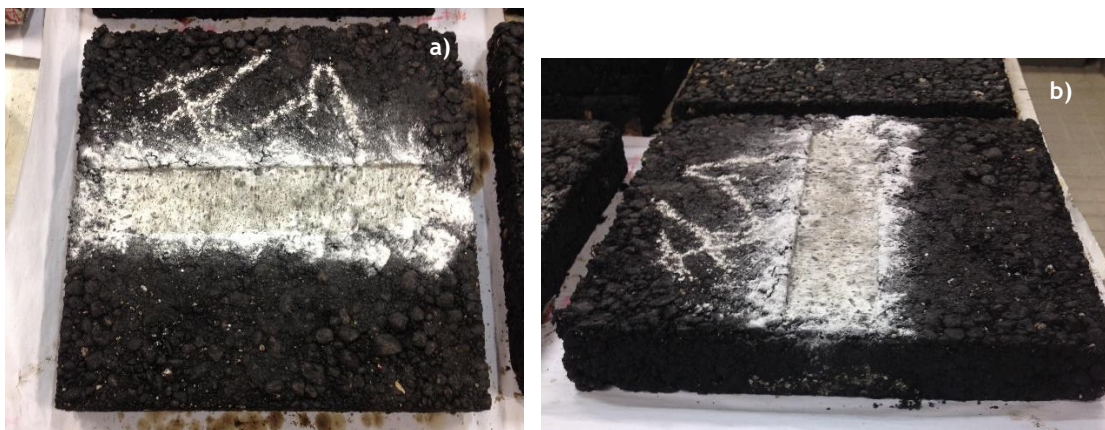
a) Lajeta após ensaio; b) Pormenor da rodeira na lajeta
